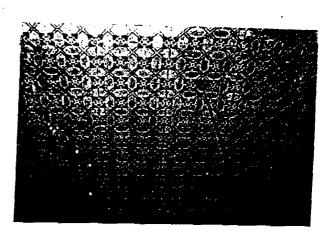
/100346 Detail plafon "emperan" bangun an belakang
